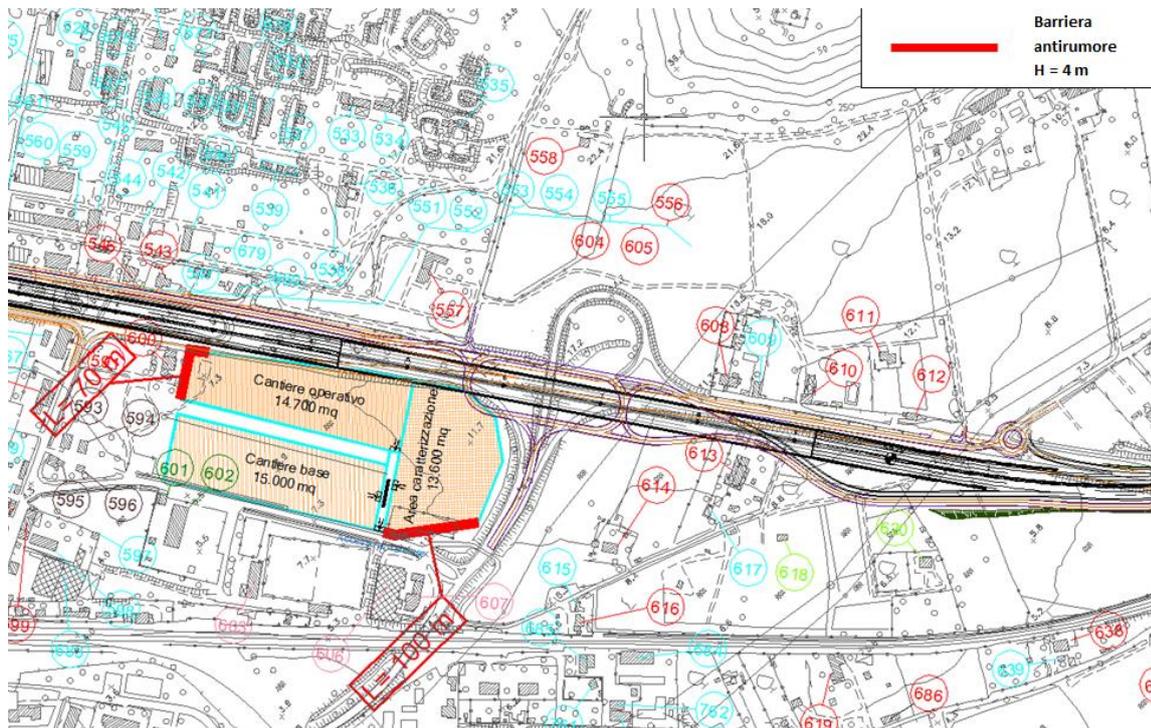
Barriere antirumore cantiere fisso.
